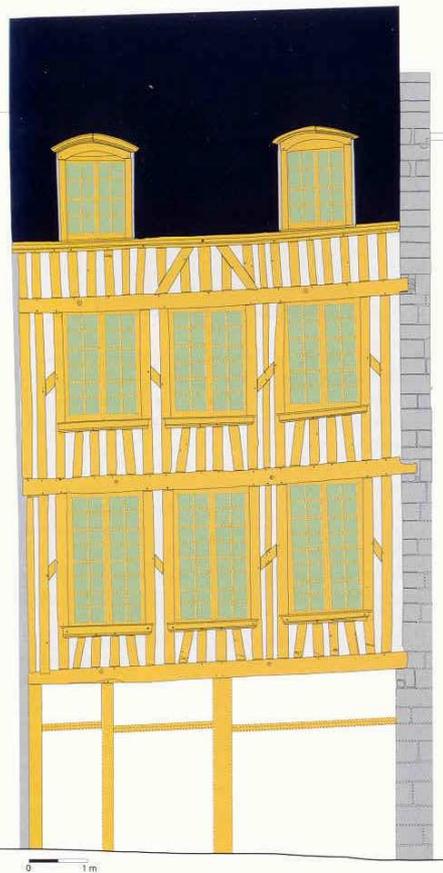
maison du 293 rue de Bourgogne : élévation restituée de la façade lors de sa reconstruction, en 1753.
